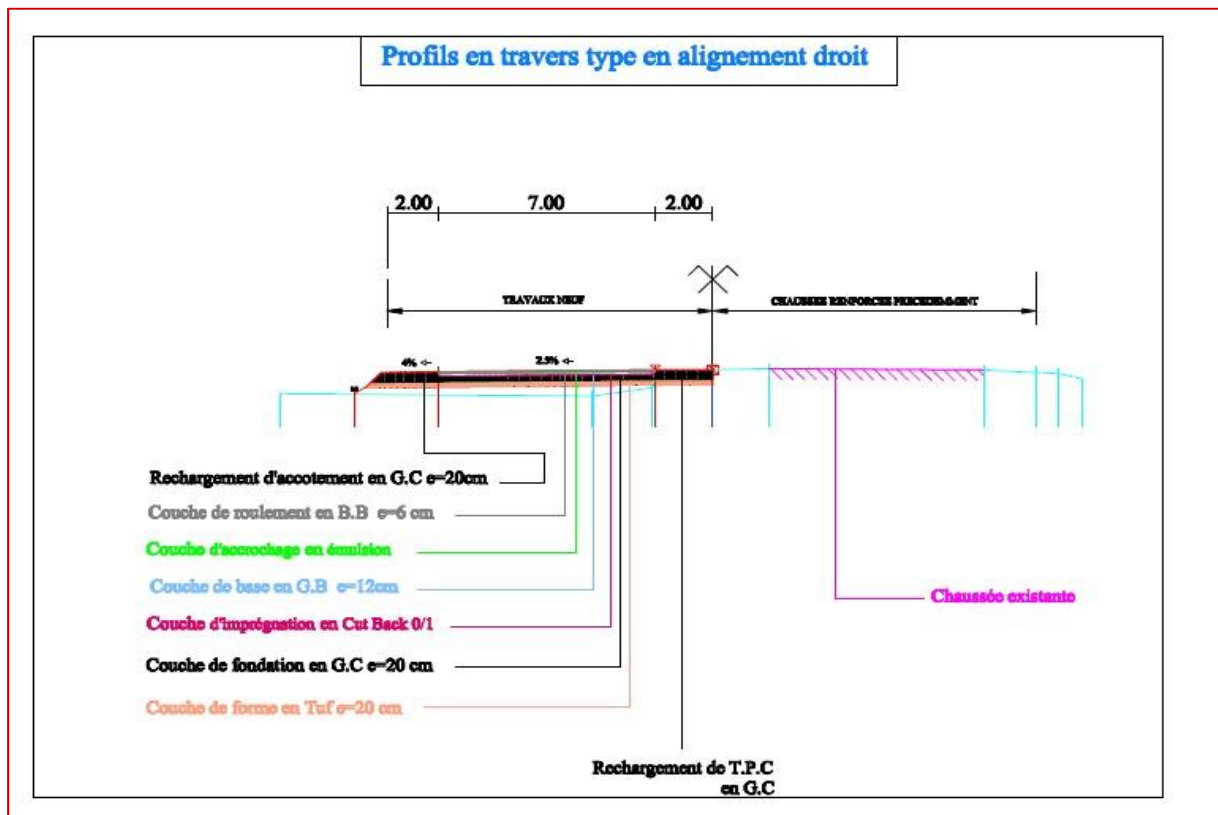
PROFIL EN TRAVERS TYPE
